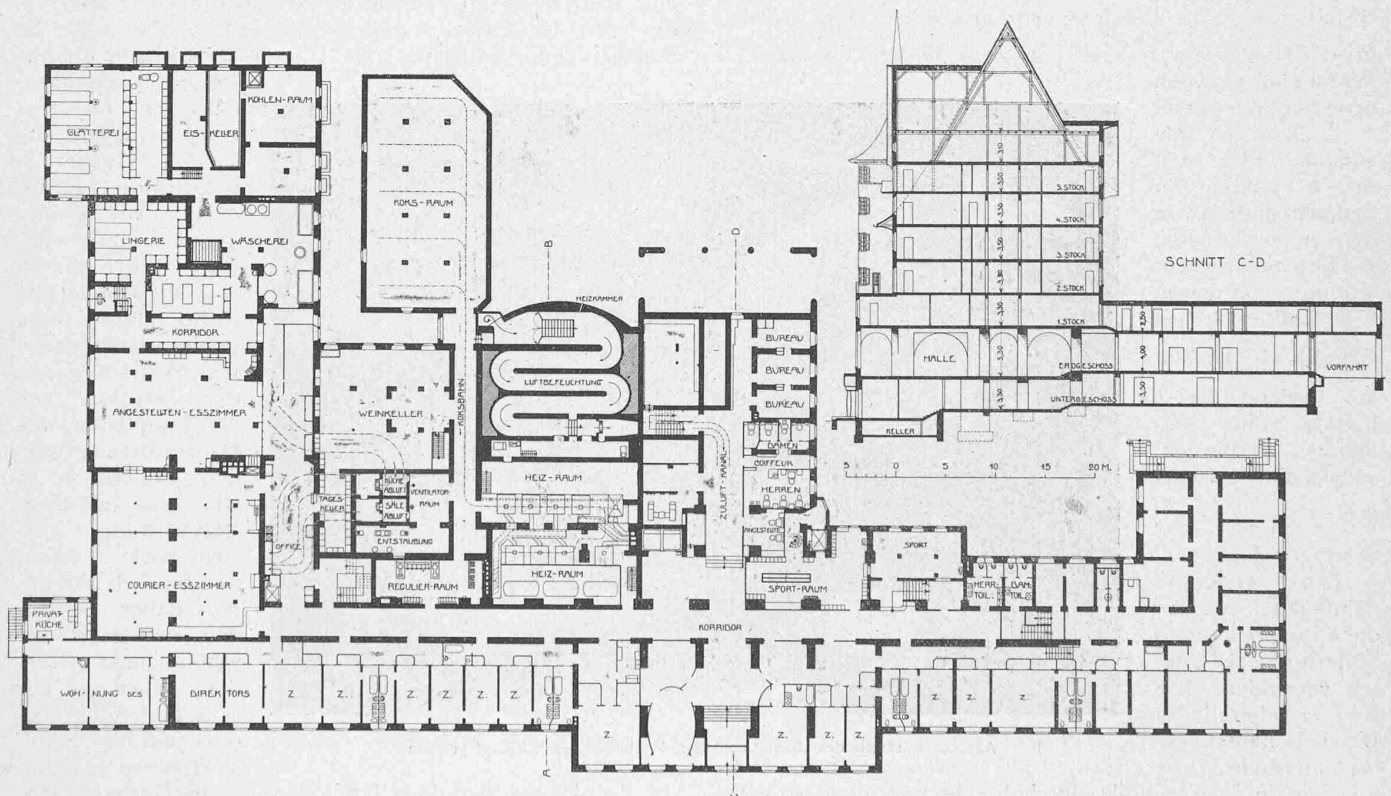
Grundriss vom Untergeschoss. — Masstab 1 : 700.
